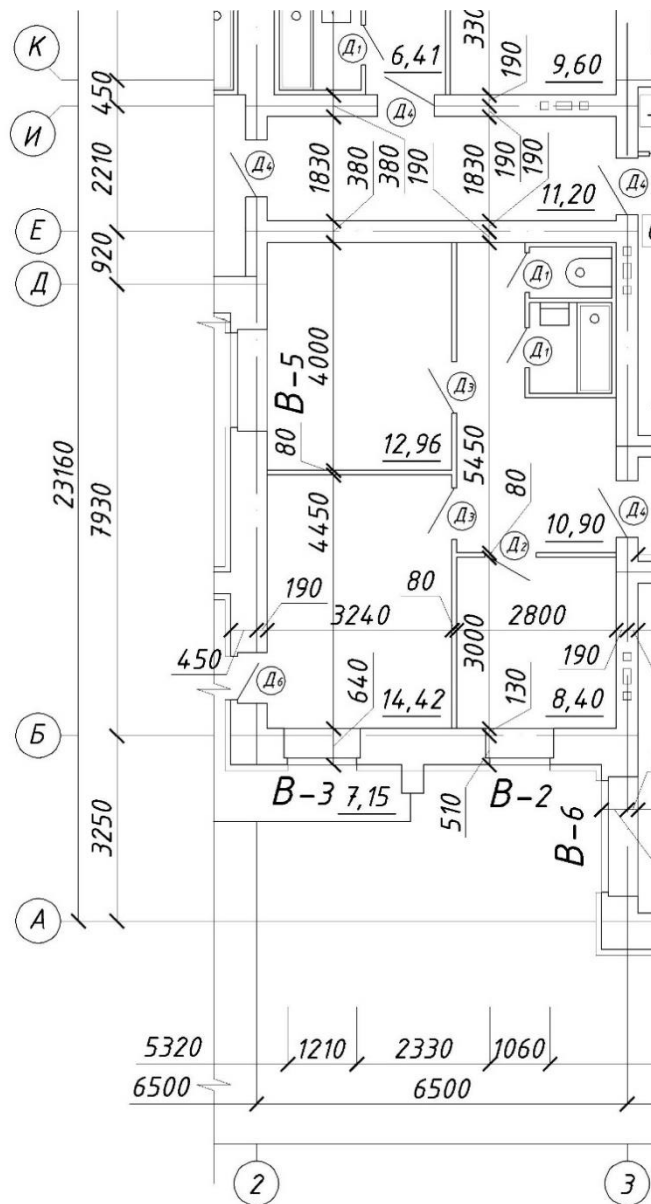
Фрагмент з плану (по вісям А-І)
